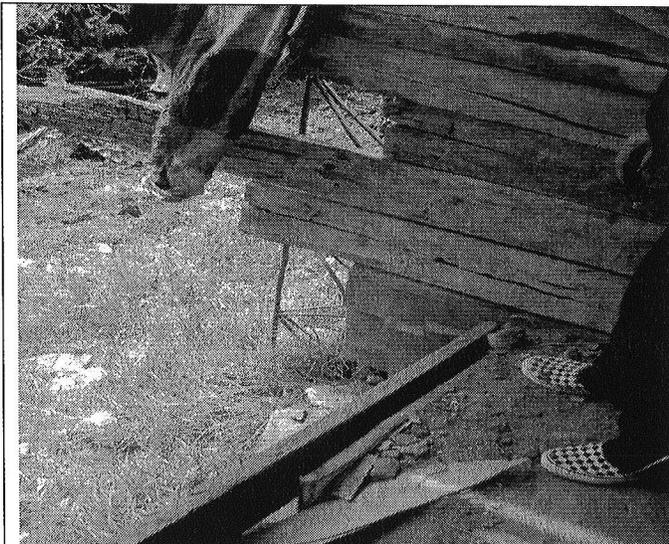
Detalle del tipo de empalmes existentes en los elementos de madera que funcionan como columnas de apoyo del entrapiso en madera. Se evidencia el estado de deterioro de los elementos y su pérdida de verticalidad. Mayo 7 de 2009.
